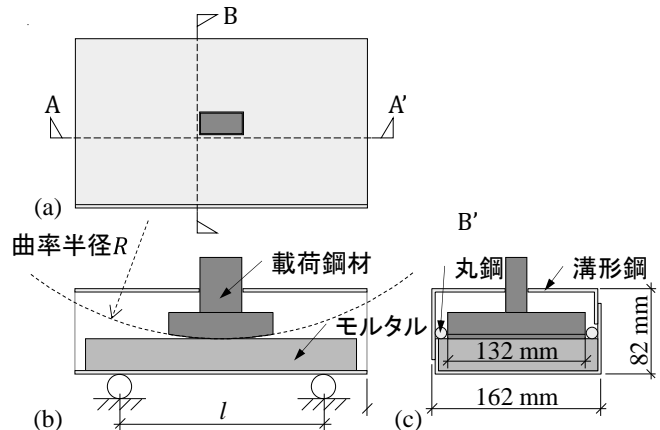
局所破壊の試験体形状：(a) 平面図；(b) AA' 断面図；(c) BB' 断面図
